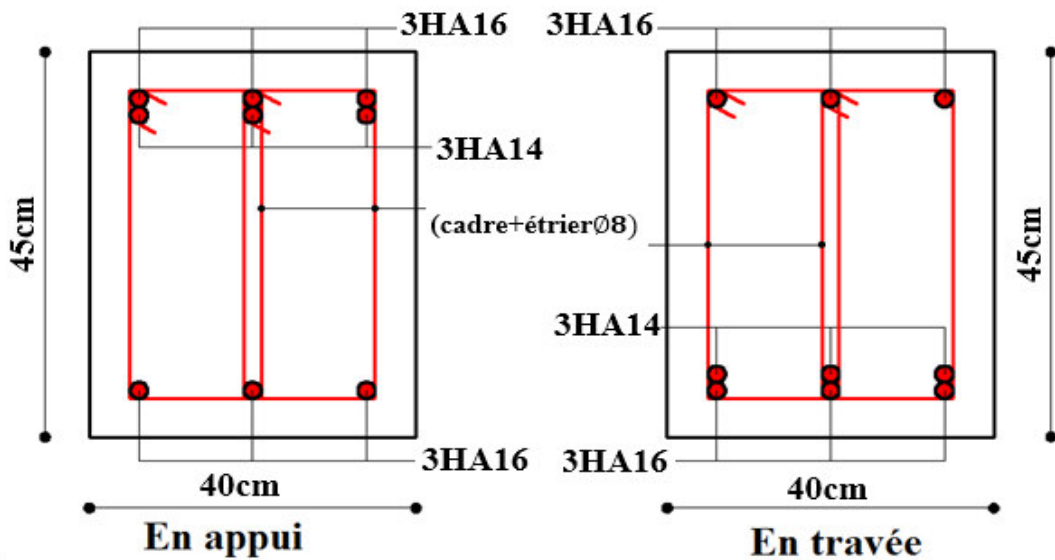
Schéma de ferrailage des poutres principales et secondaires pour tous les niveaux.
